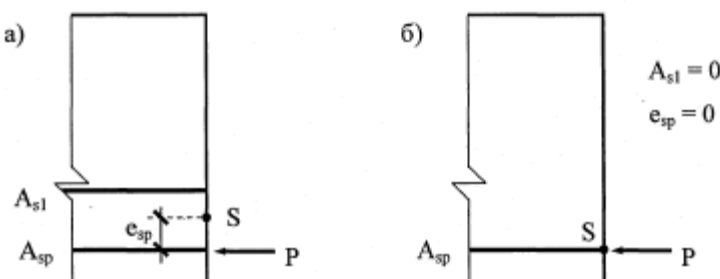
К определению величины  $e_{sp}$ : а) конструкция с двухрядным расположением арматуры по высоте сечения; б) конструкция с однорядным расположением арматуры по высоте сечения;  $S$  - центр тяжести площади поперечного сечения всей растянутой арматуры.
